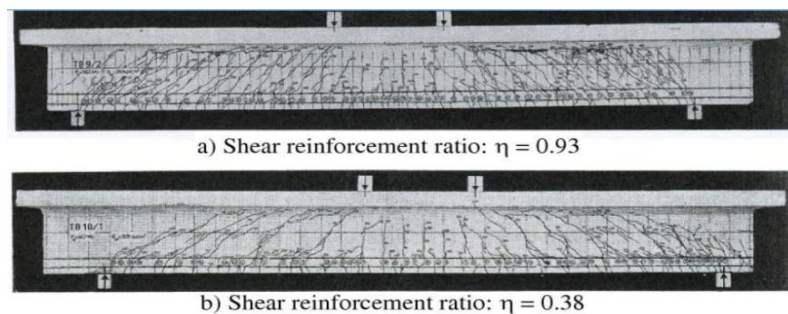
Patrón de grietas en vigas T con diferentes cantidades de refuerzo de corte (Leonhardt y Mönnig, 1973).
